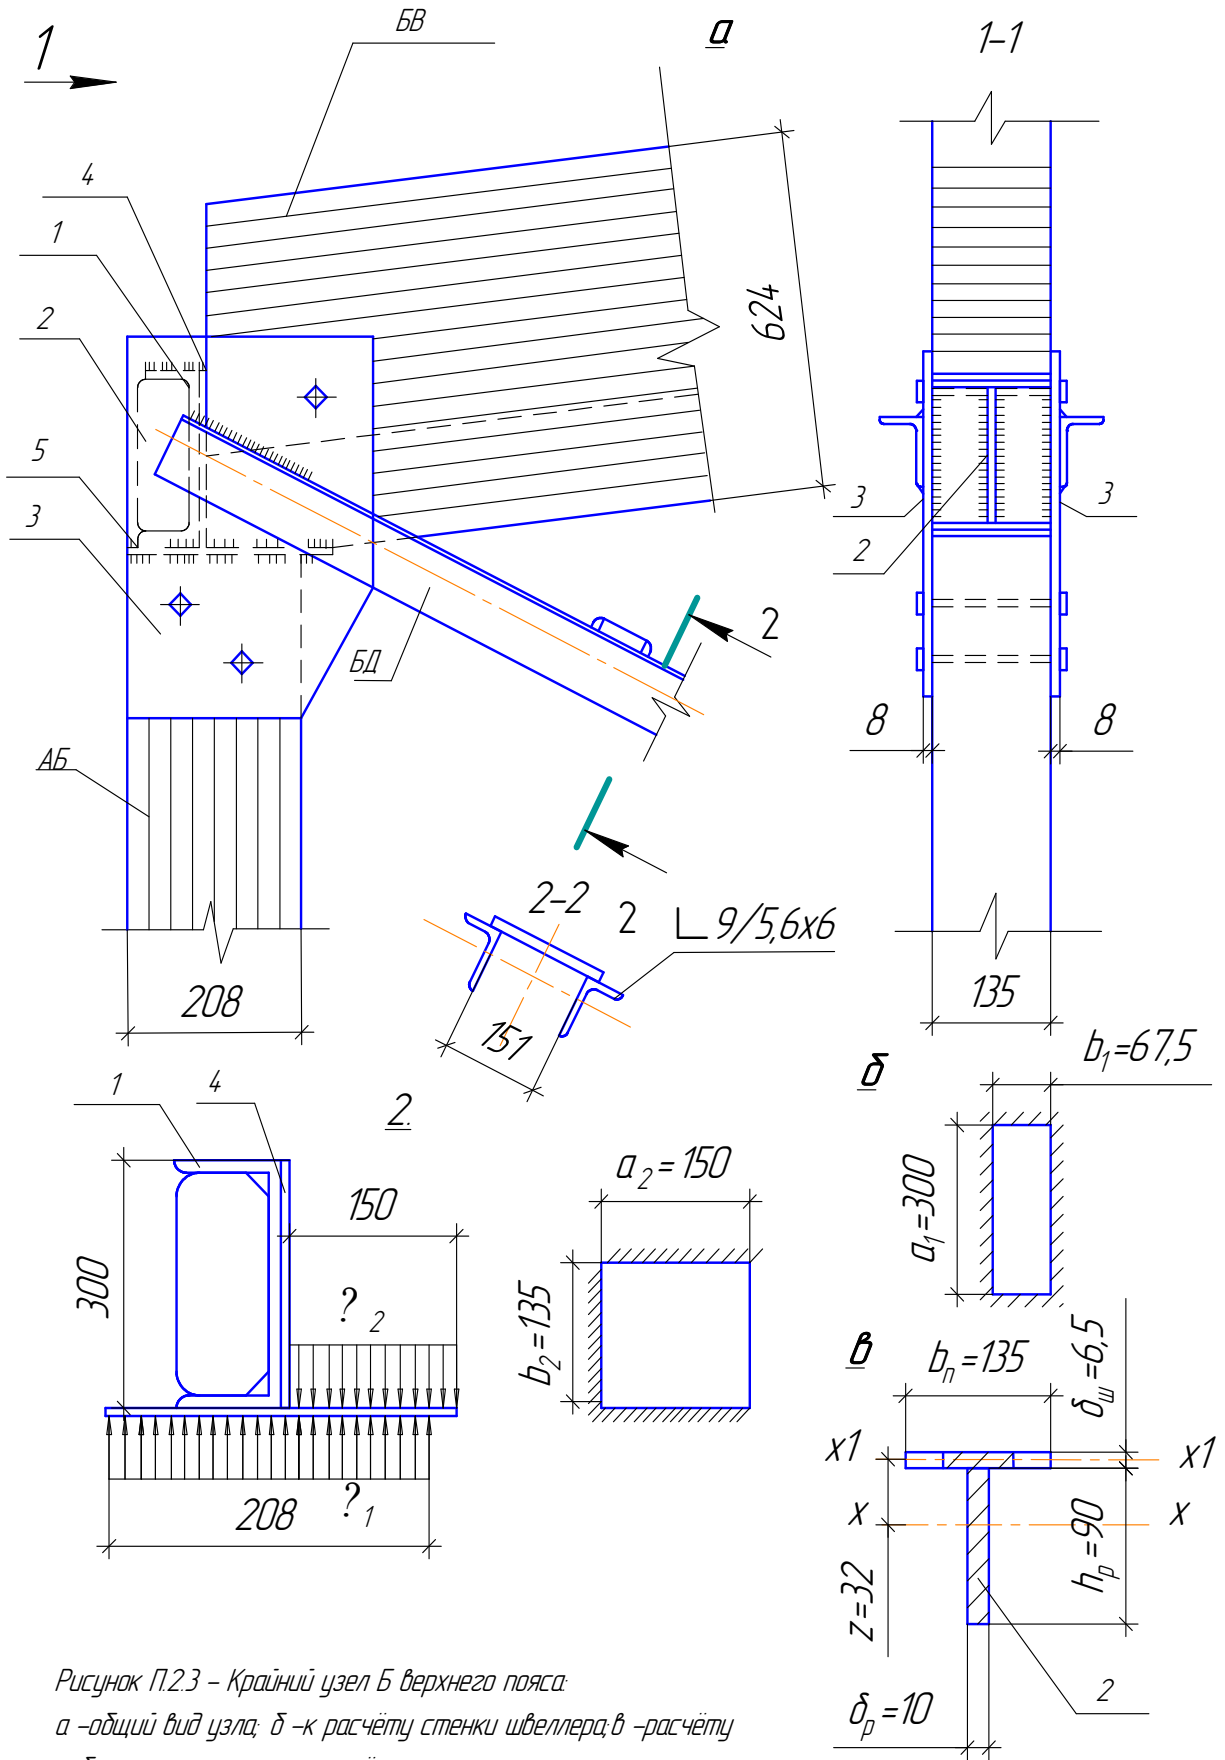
Крайний узел Б верхнего пояса:
